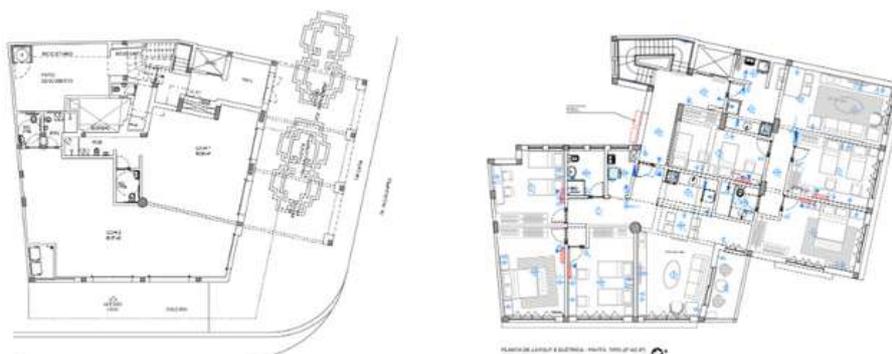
e 43 -Planta Baixa do Pavimento Térreo e Tipo.
